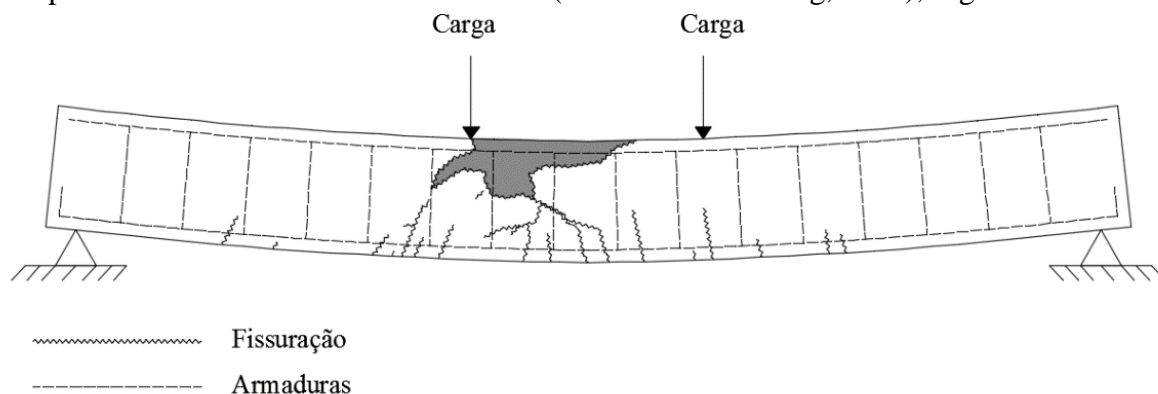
Rotura do betão em viga de betão armado (Silva, 2015)
